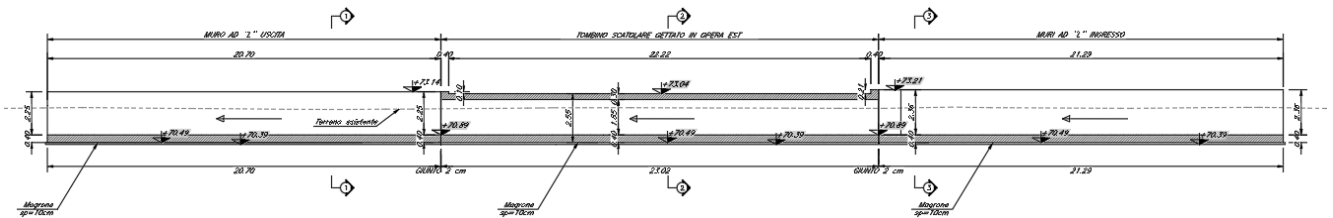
Sezione longitudinale tombino stradale est su via Caiselli
